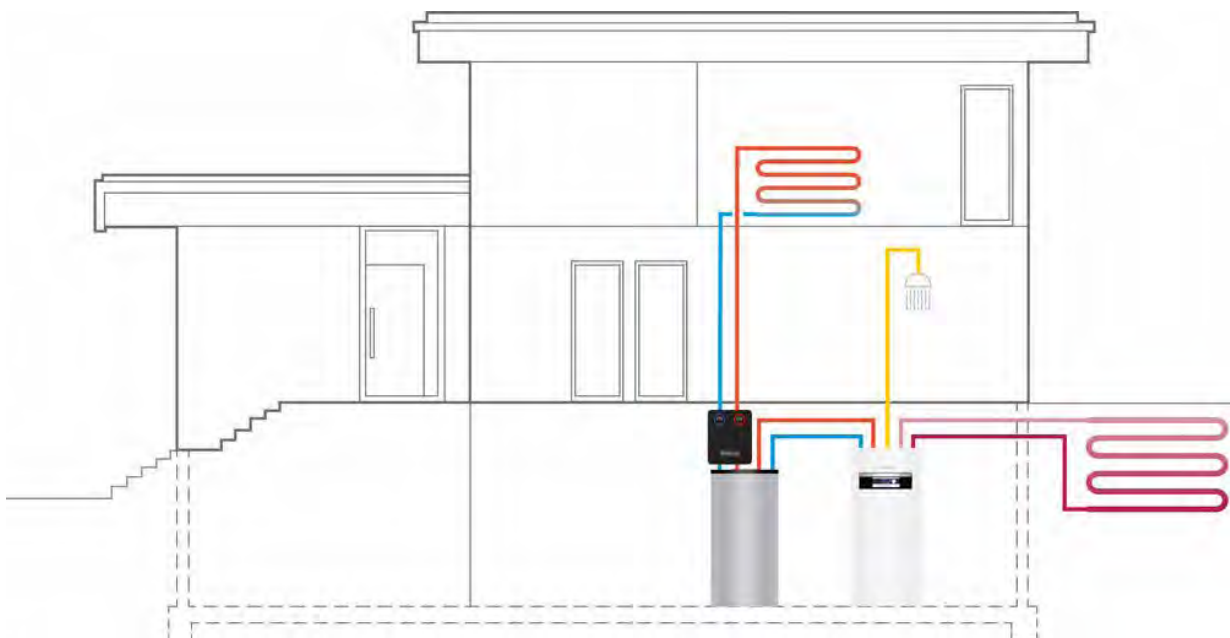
Systembild einer Erdwärmepumpe mit Erdkollektor
